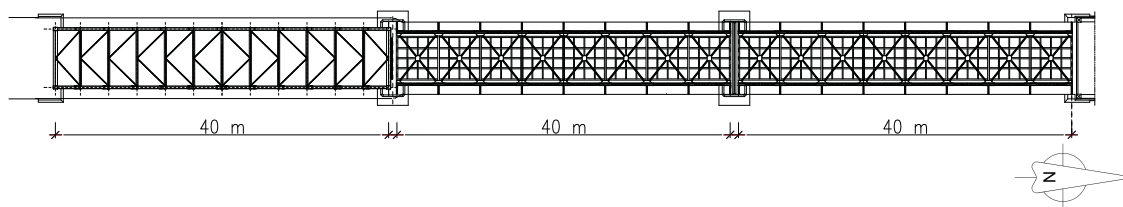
Desenho em planta da vista inferior do tabuleiro da ponte.
